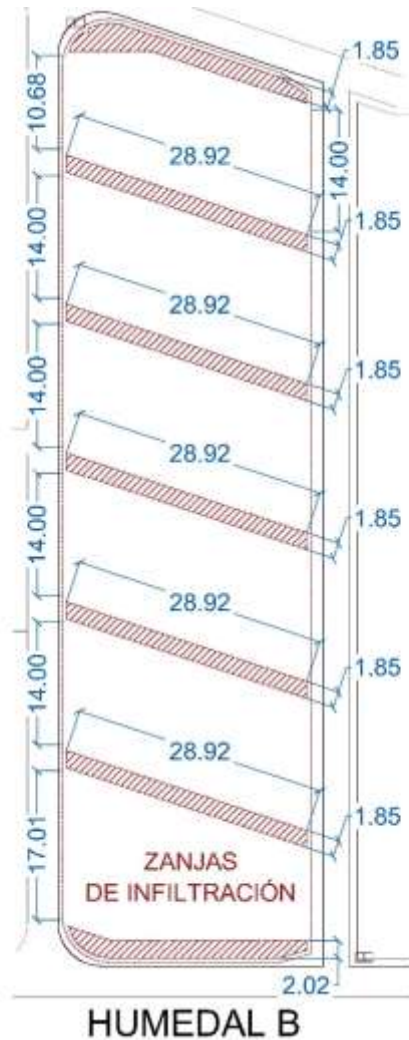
Detalle de las zanjas de infiltración en el humedal (Fuente: Planos del proyecto de rehabilitación).
